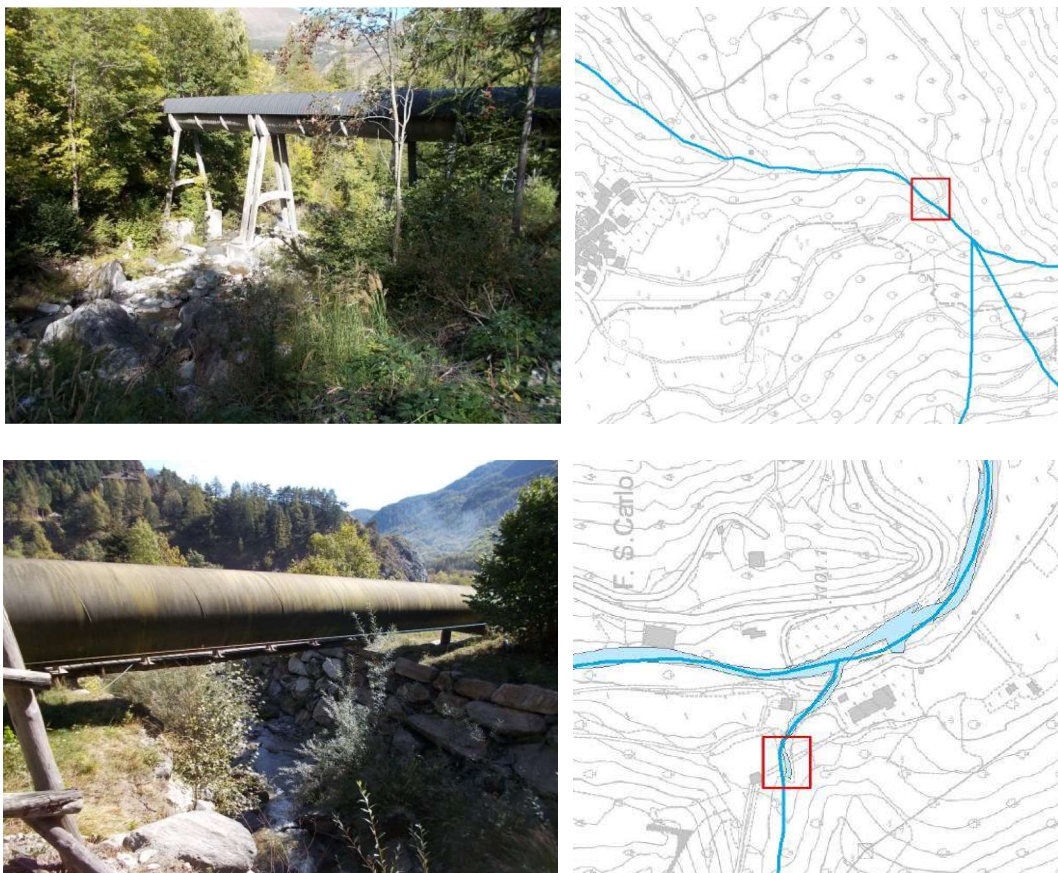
Ponte tubo sul Rio Laux (foto sopra) e attraversamento della condotta sul Rio Crestovo (foto sotto).
